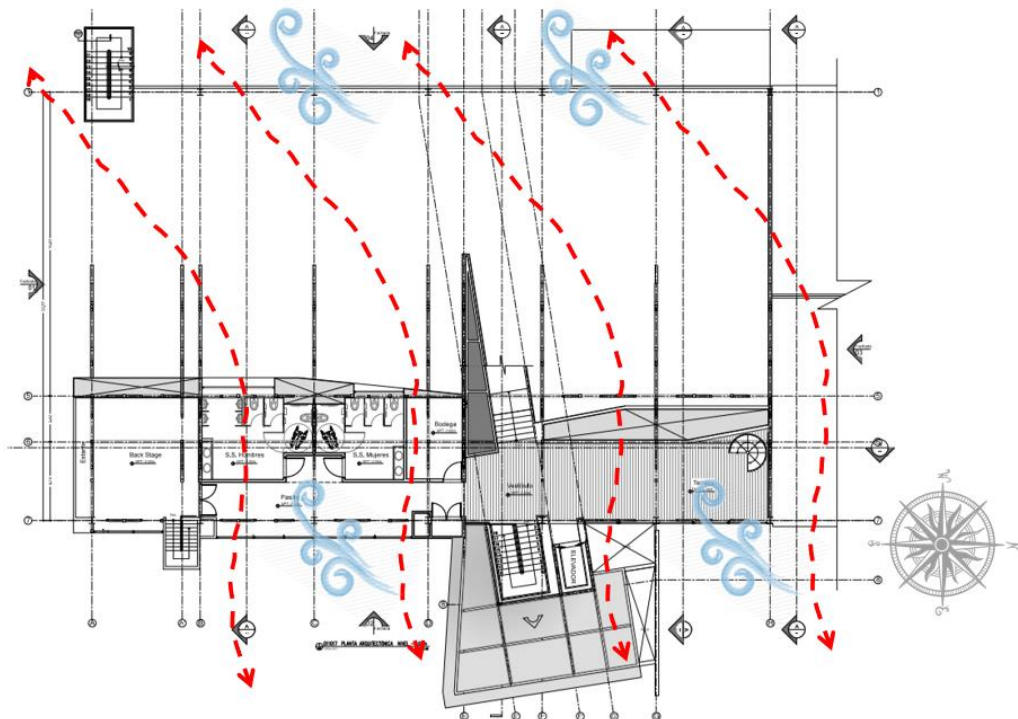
Planta de distribución arquitectónica, desarrollada por el autor (2019).
